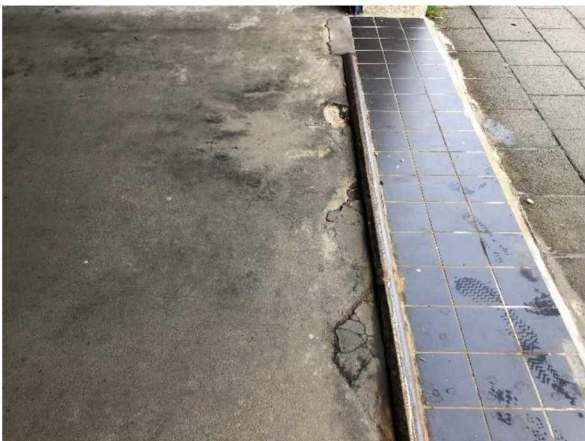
Losliggende betonnen delen ter plaatse van ingang.
